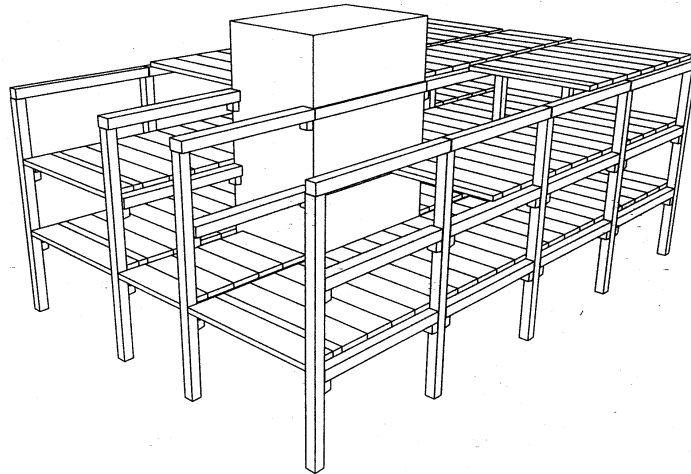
Typische geprefabriceerde skeletconstructie met centrale kern voor de stabiliteit
